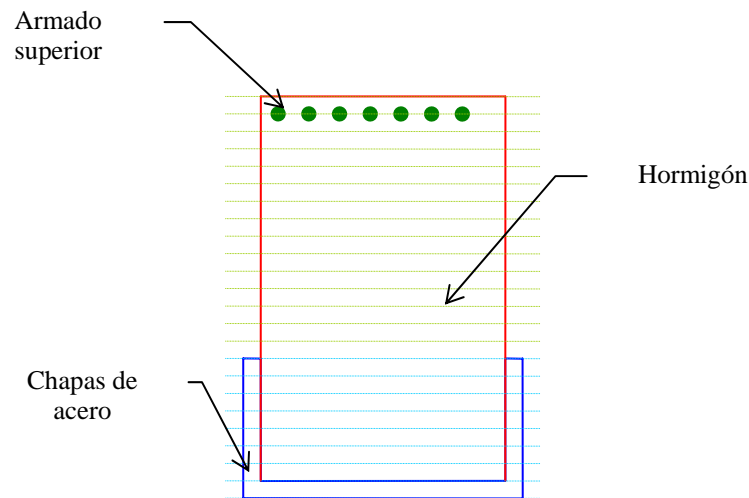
Ejemplo de discretización de una sección de hormigón semiembibida en chapas metálicas soldadas
